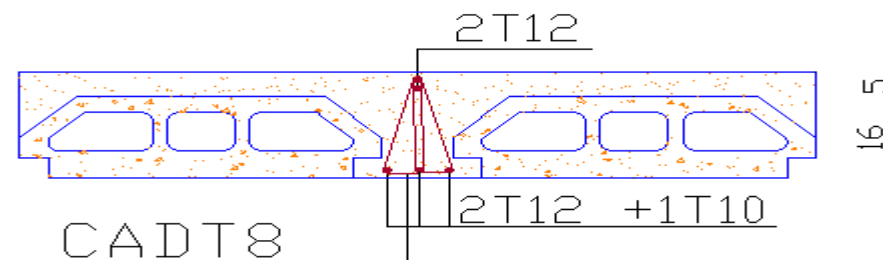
Schéma de ferrailage des poutrelles d'étage courant sur appui.
